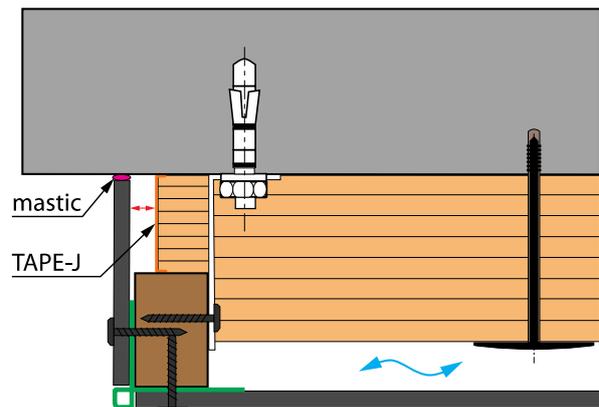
Arrêt latéral de façade : espace entre l'HYBRIS et la rive
